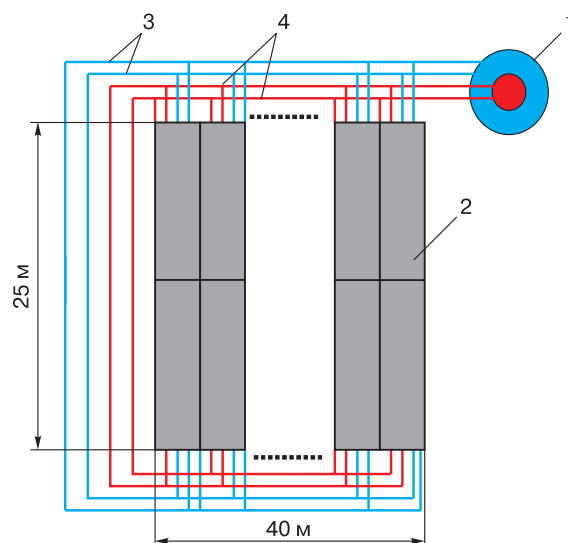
Схема подключения фундаментных модулей к теплому насосу.
